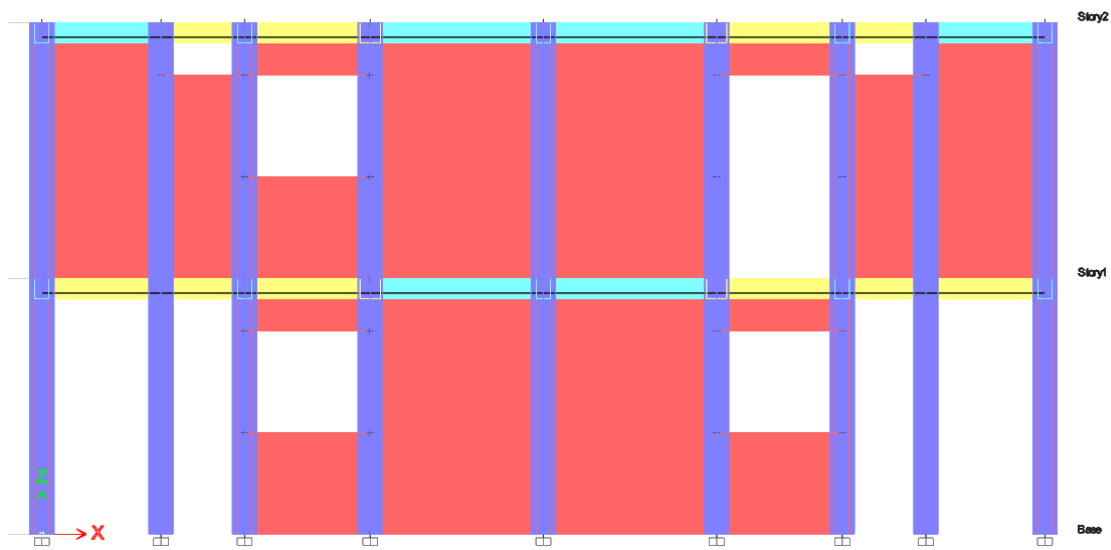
Vista frontal de la estructura de Mampostería confinada. Fuente: Propia
